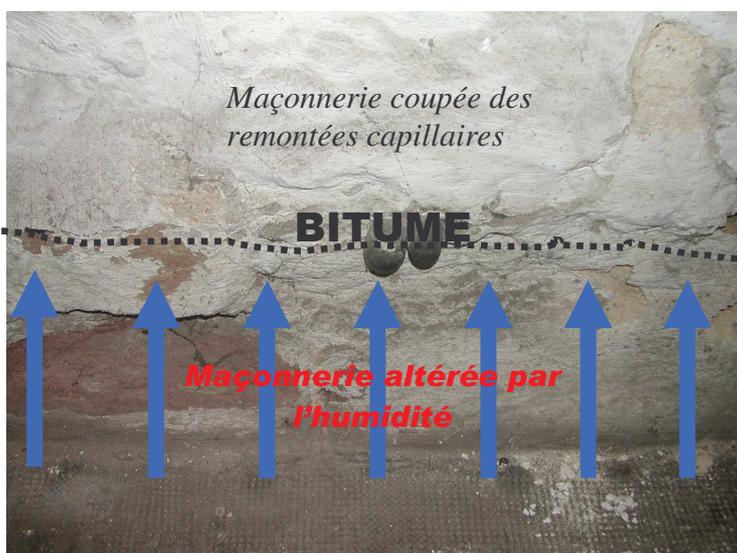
protection contre les remontées capillaires dans la cave du bâtiment 2
